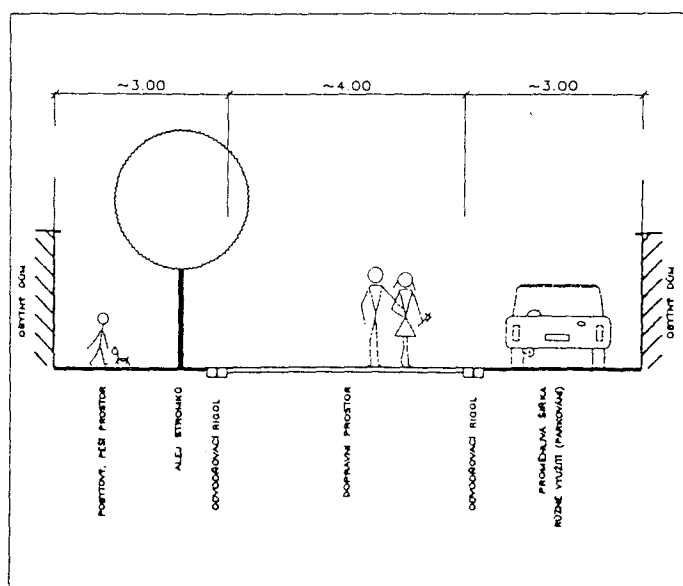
Příklad řešení příčného řezu obytné ulice v zástavbě městského typu (srovnej též s obr. 30)
